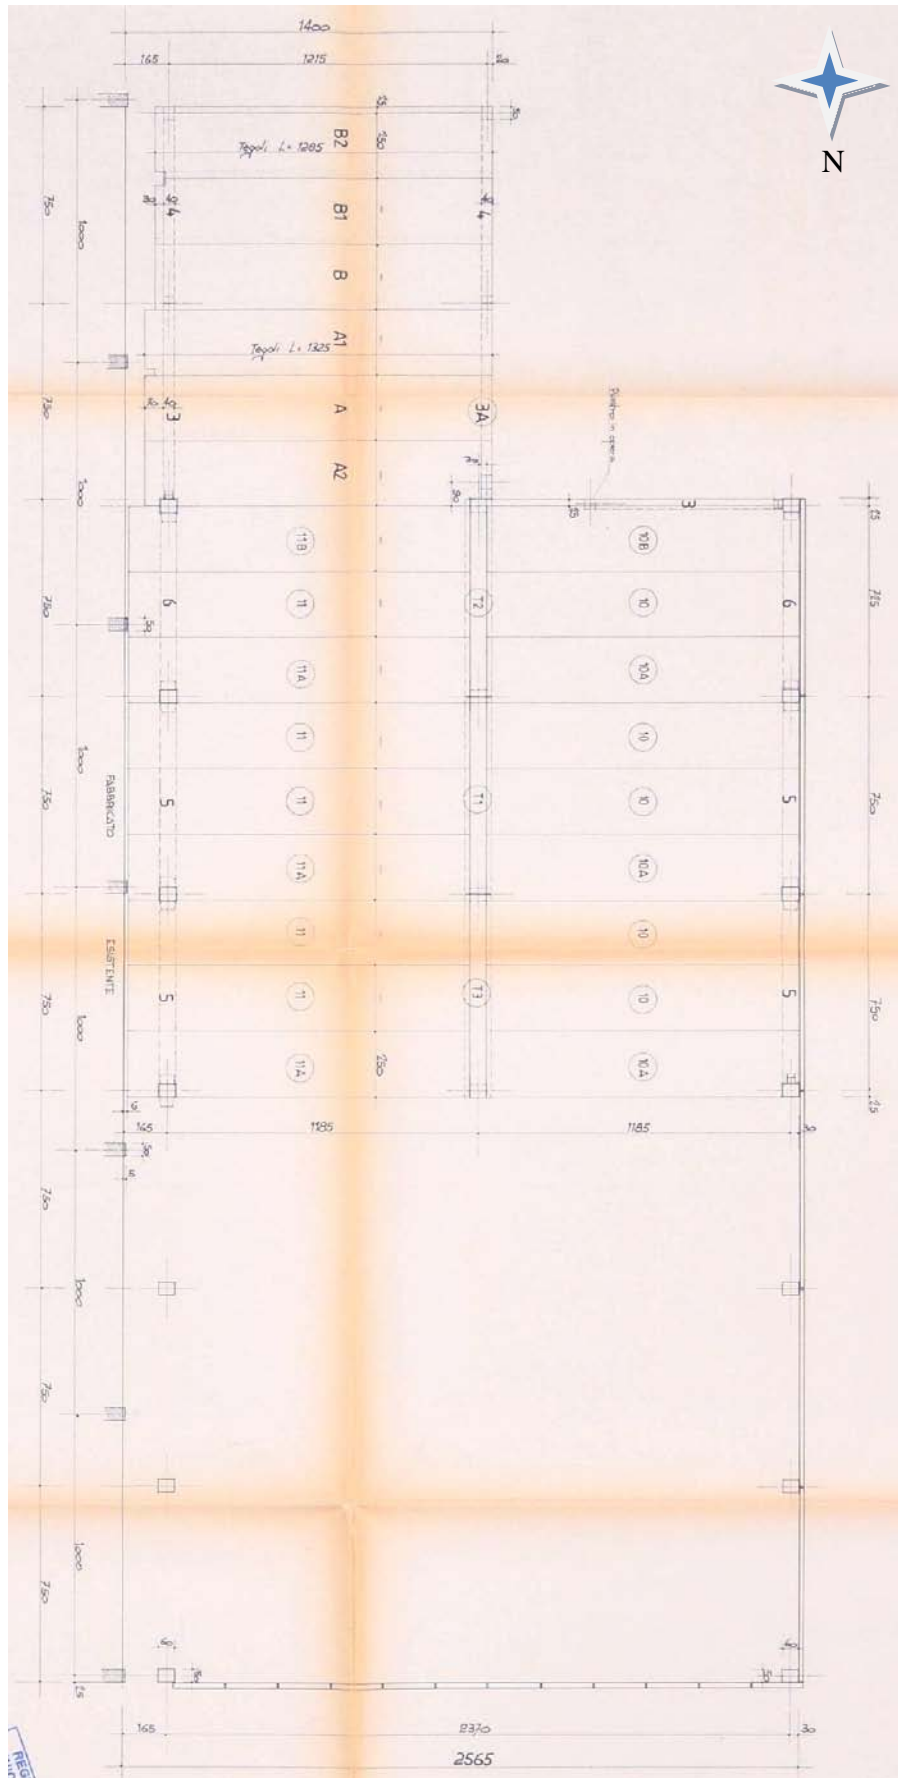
Particolare di A.1990.cap.us.T10 - Pianta primo solaio
